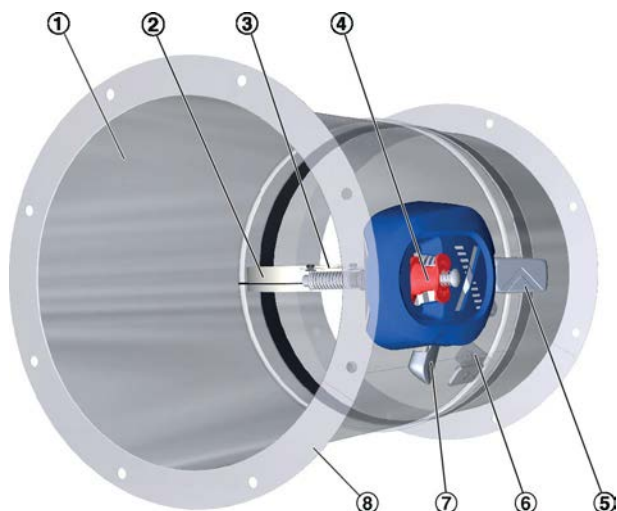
FKR-EU mit Schmelzlot (Abb. Flanschausführung)
